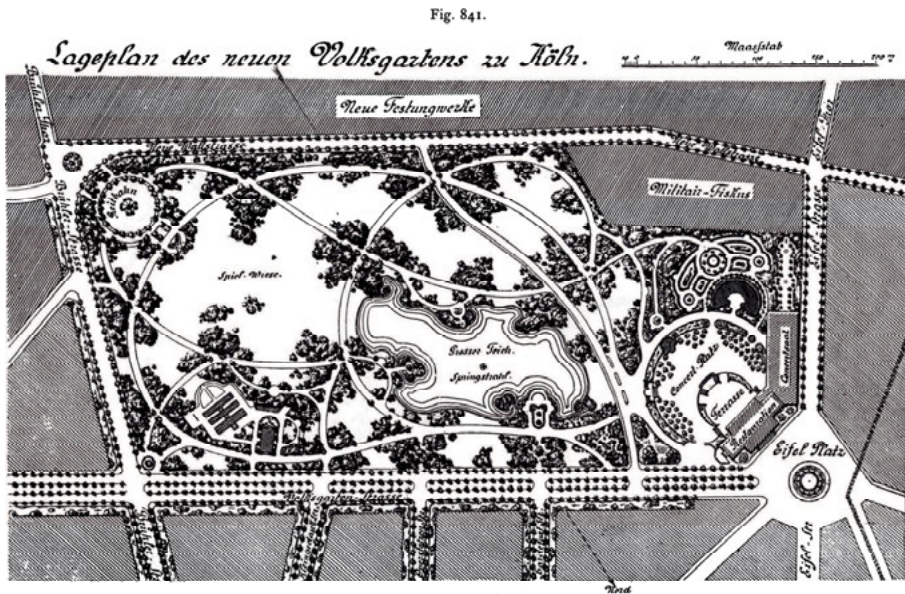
Grundrissplan des Kölner Volksgartens
